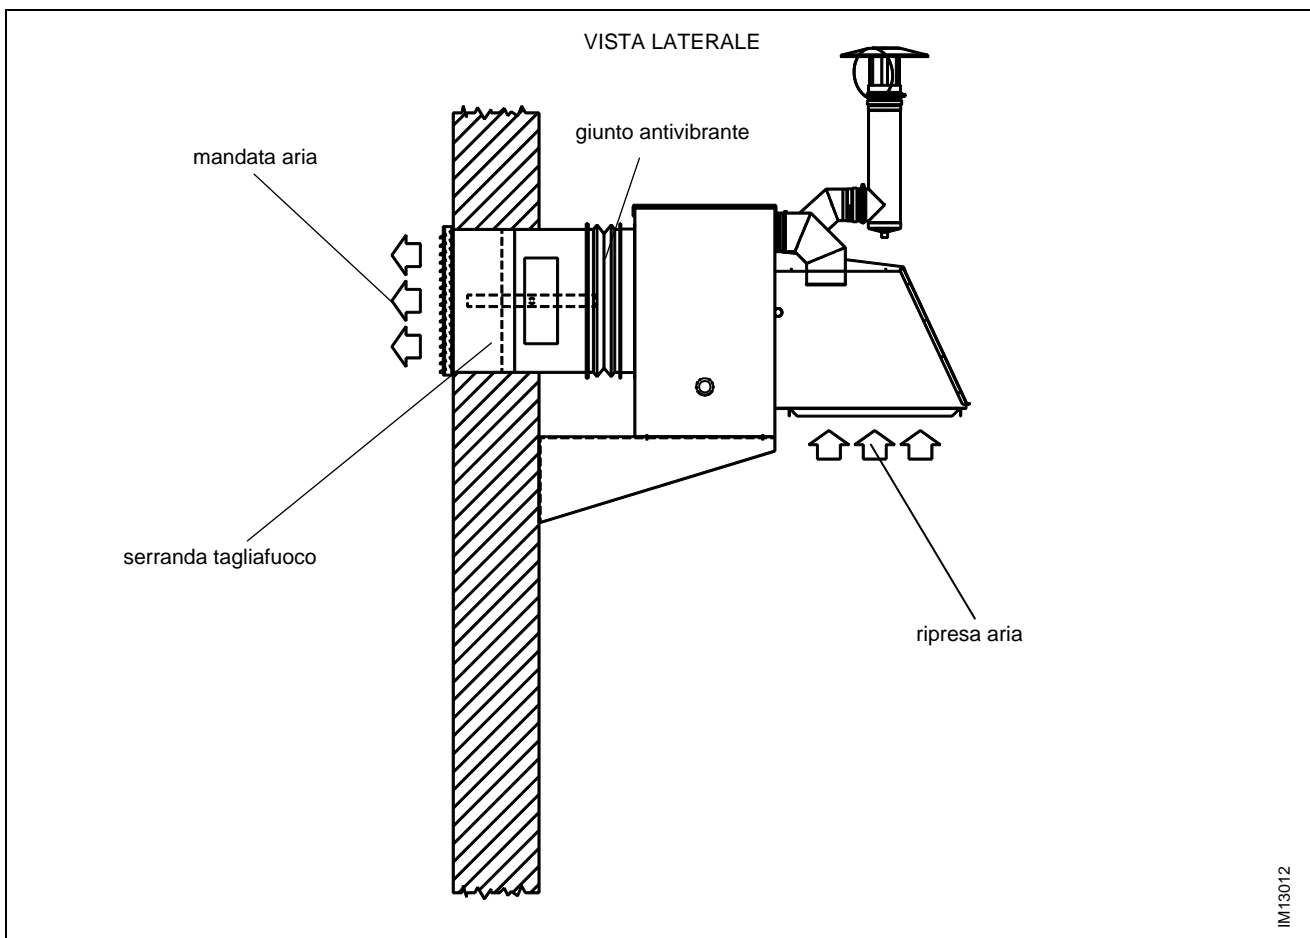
ESEMPIO DI INSTALLAZIONE A PARETE CON TOTALE RIPRESA ESTERNA
